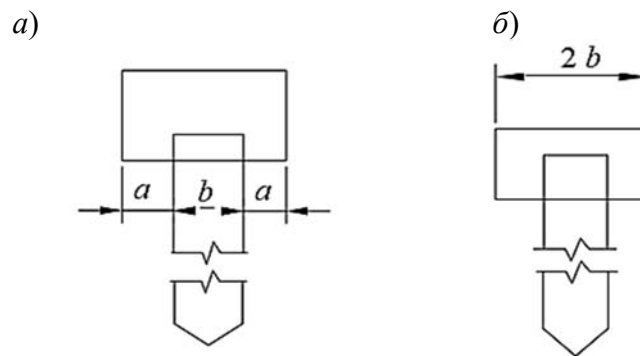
К расчету ширины монолитного ростверка свайного фундамента
